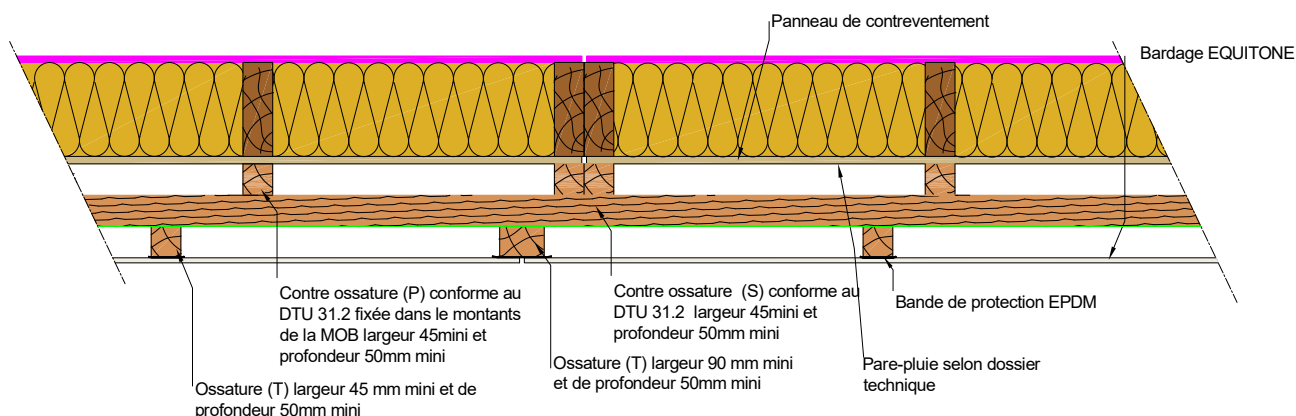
Pose sur 2 contre-ossatures – Coupe horizontale – Pose sur COB ou CLT
